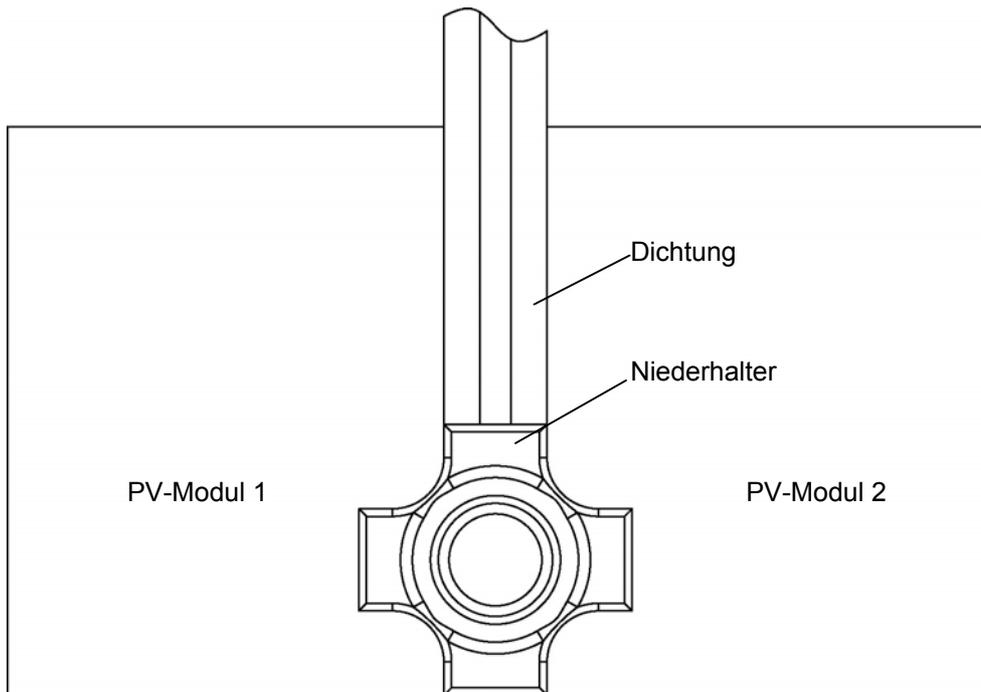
Niederhalter eines Zweier-Modulverbinders am Modulflächenrand, Indach-Variante
